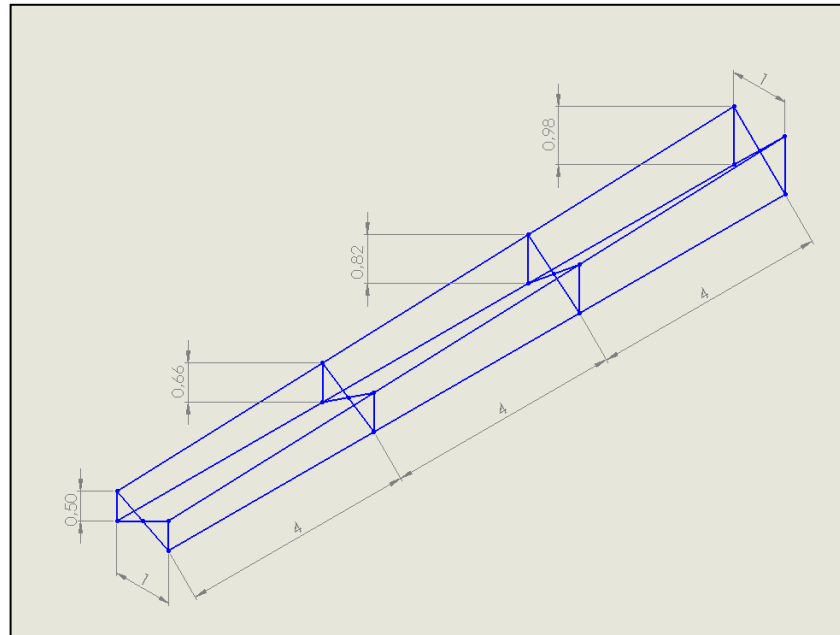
Vista isométrica de la estructura. Unidades: metros (m).
